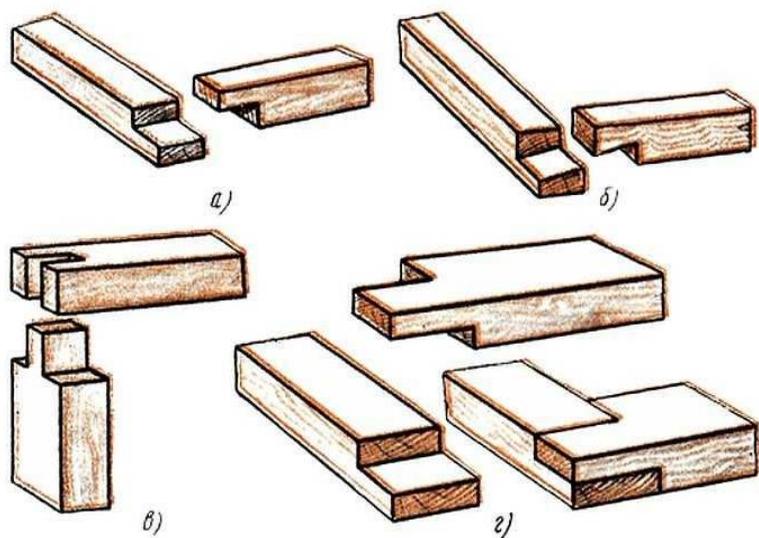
Соединение брусьев: а) – вполдерева; б) – вполулапу; в) – шиповое; г) – угловое
